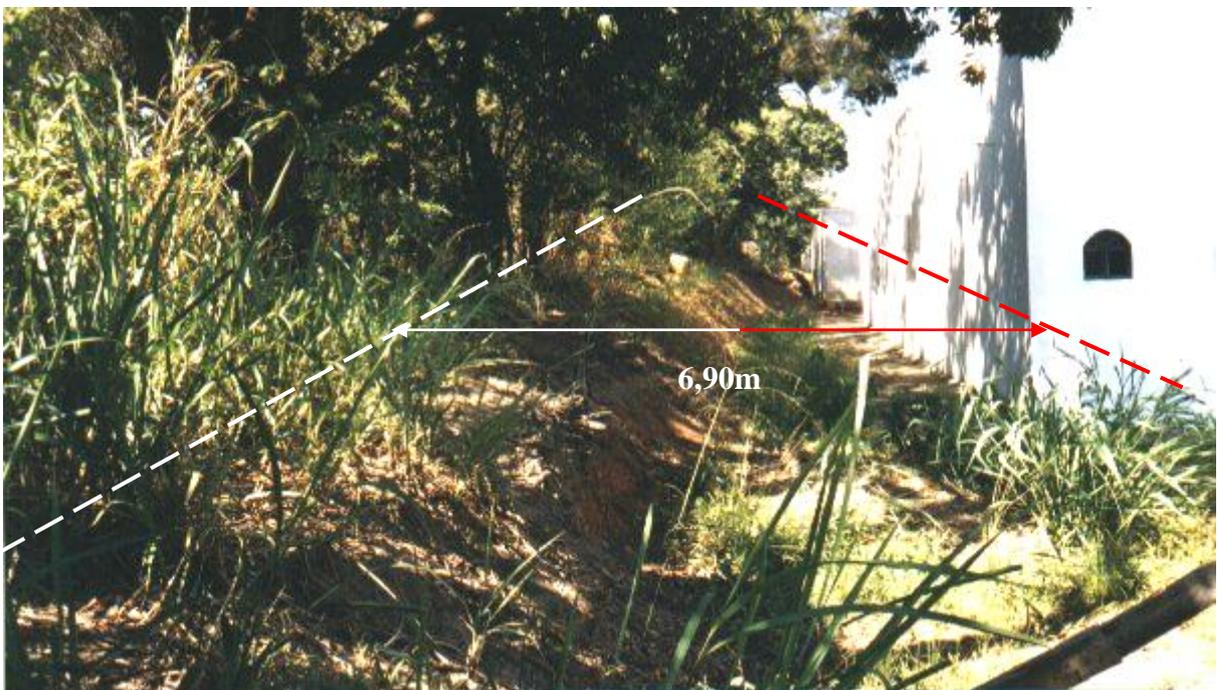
Detalhe de erro de locação da obra do Réu – A testada da obra foi locada a 6,90m da cerca existente da divisa lateral direita do terreno – Vide plantas da topografia – O erro observado, paradoxalmente, reduziu a área do terreno do Autor ocupada indevidamente, face à tal demarcação errônea da obra do Réu, mas acentuou a invasão de área do logradouro público (Rua Guandu Mirim) – Vide Anexo 03 – Área da Lide e Alinhamento dos Logradouros.
